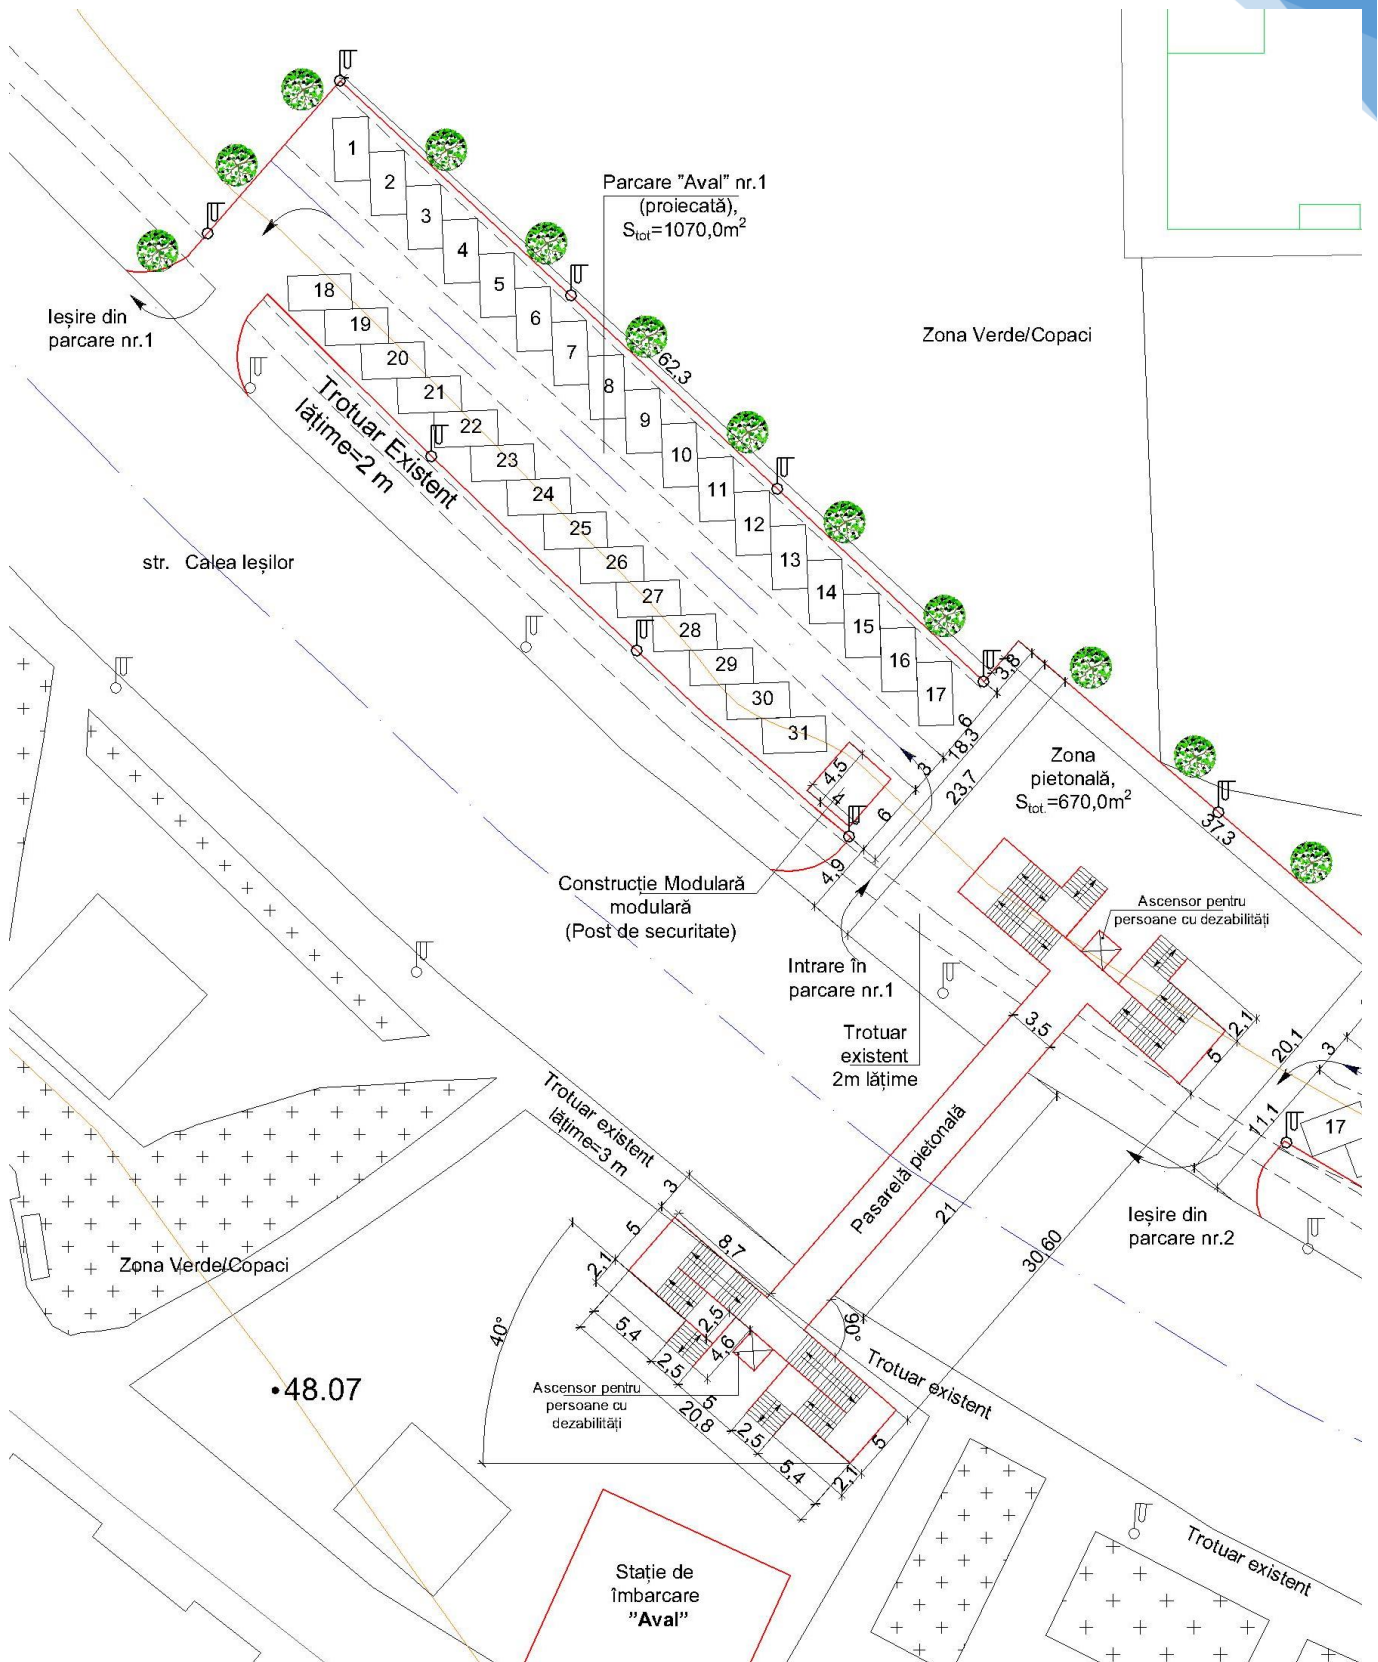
Amplasare în plan, Parcare "AVAL" nr.1
